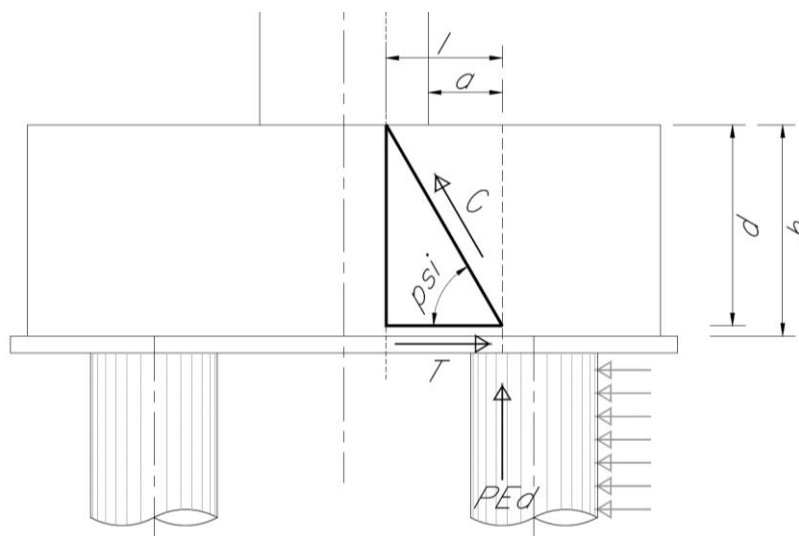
Tirante puntone - Biella compressa di calcestruzzo C e tirante di armatura T
